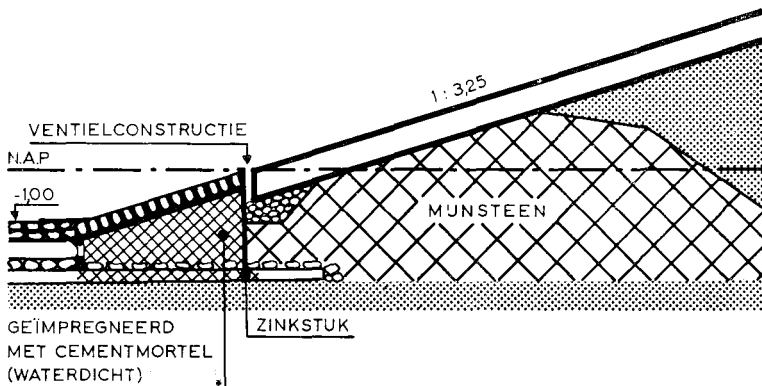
Teenconstructie van het talud van de Boulevard te Vlissingen.
